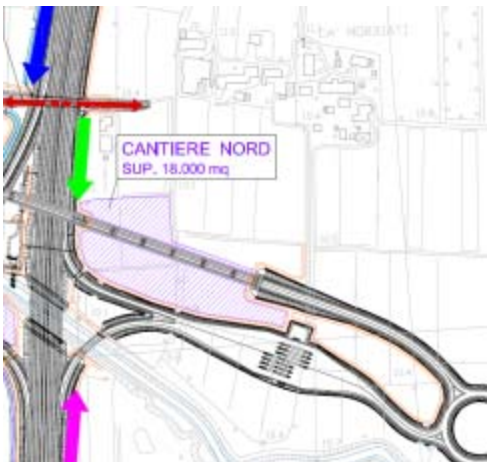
Area di cantiere nord per la realizzazione del Nuovo Casello di Martellago (estratto dalla tavola B3500.ST.PG.004 del SIA – Illustrazione della cantierizzazione del Nuovo Casello di Martellago)
